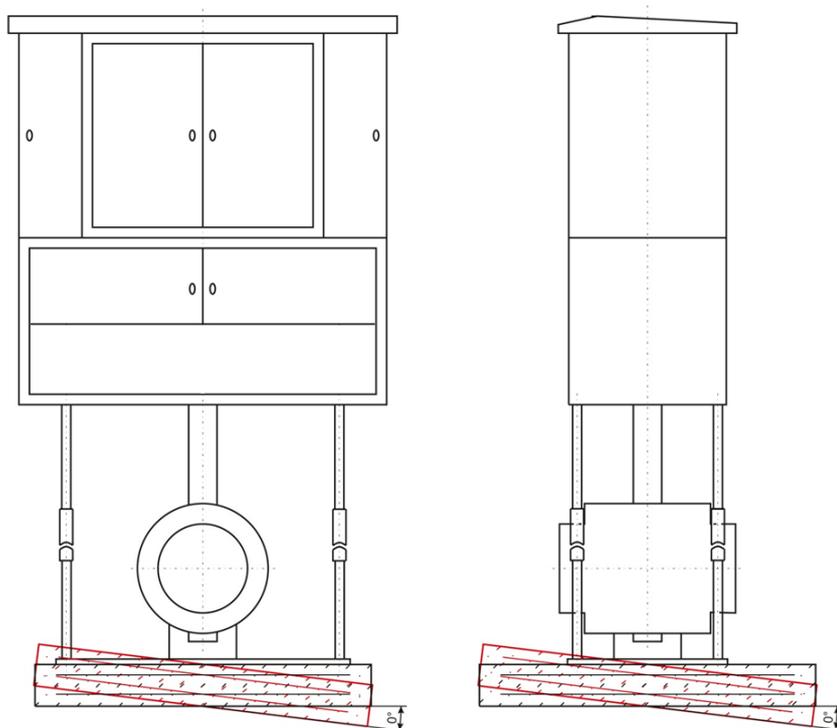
Размещение опорной рамы шарового крана на монтажной площадке
